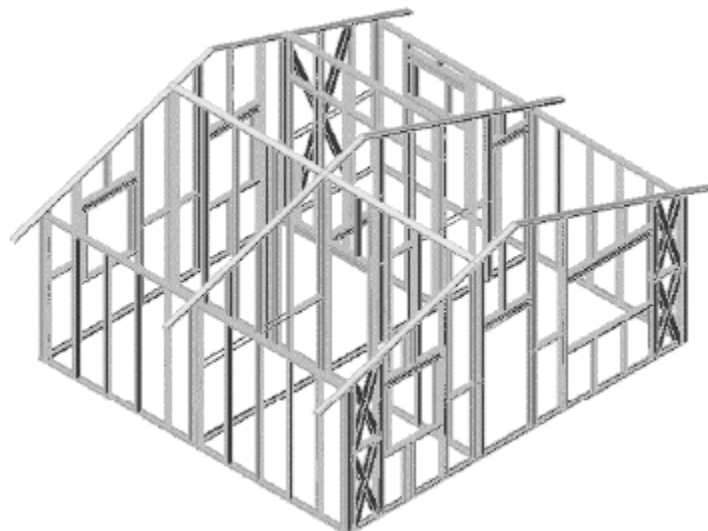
Modelo construtivo do Light Steel Framing (Soares, 2002).
